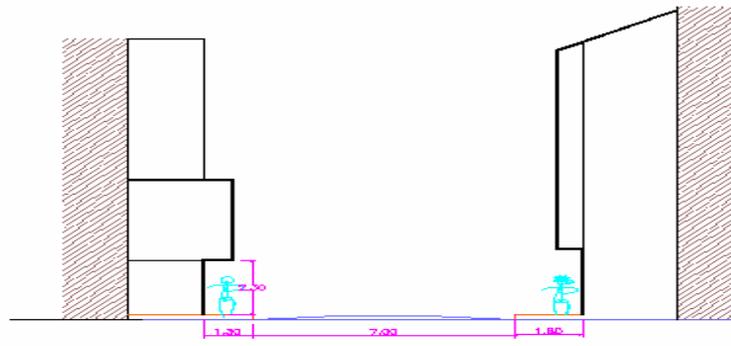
PERFIL URBANO ZONA CENTRAL
